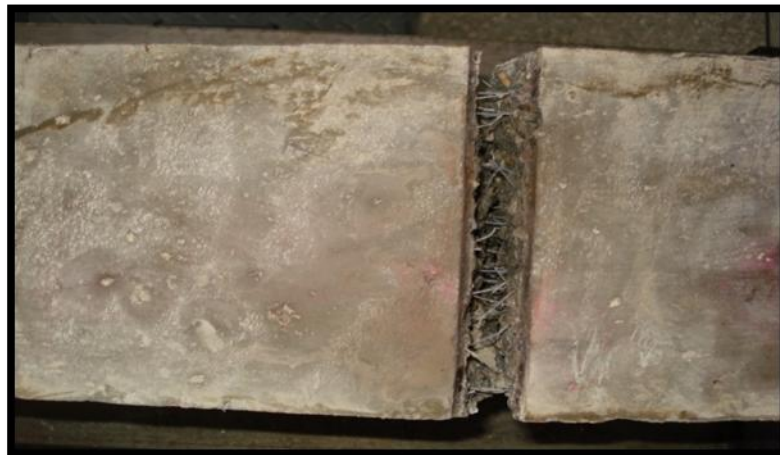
Vigueta Ensayada donde se aprecian las Fibras de Acero
